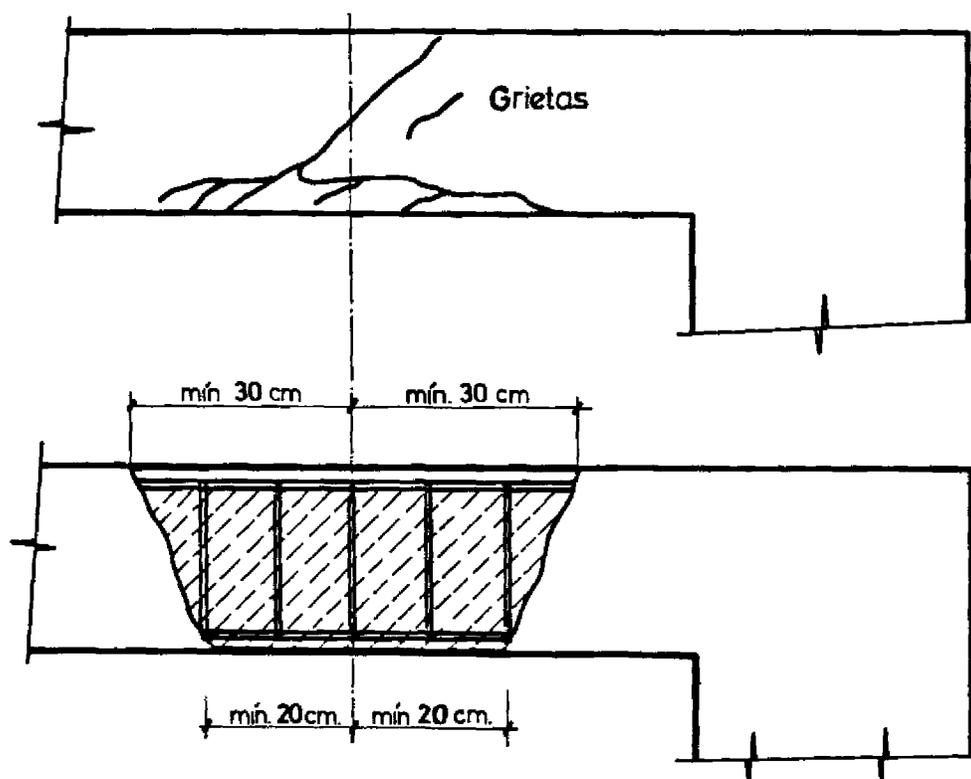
Caso V-1. REPARACION DE VIGA CON HORMIGON PREMOLDEADO
